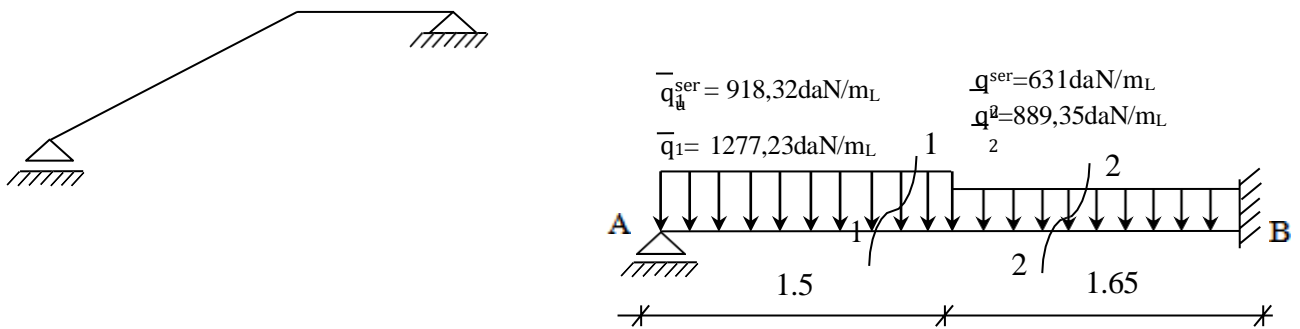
Schéma statique d'un escalier à paillasse avec palier
